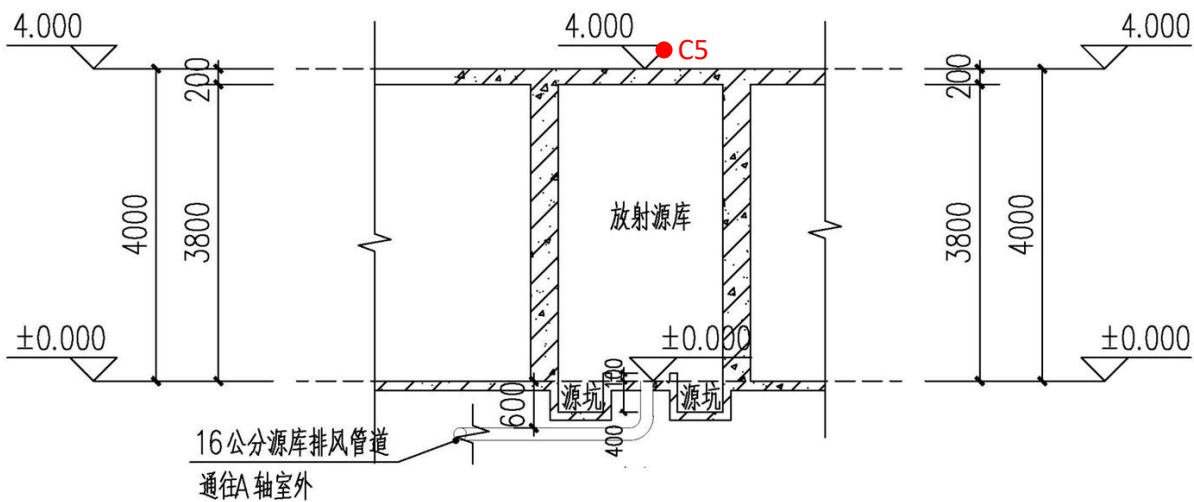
放射源库平面布局及预测点位示意图（单位：mm）
